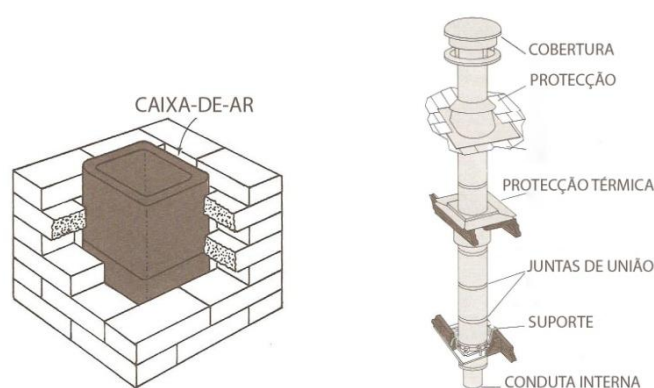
Chaminé em alvenaria de tijolo e em conduta metálica [3]
